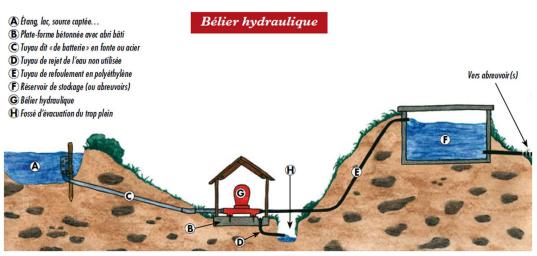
Schéma d'installation d'un bélier hydraulique (source : contrat de rivière Célé)
